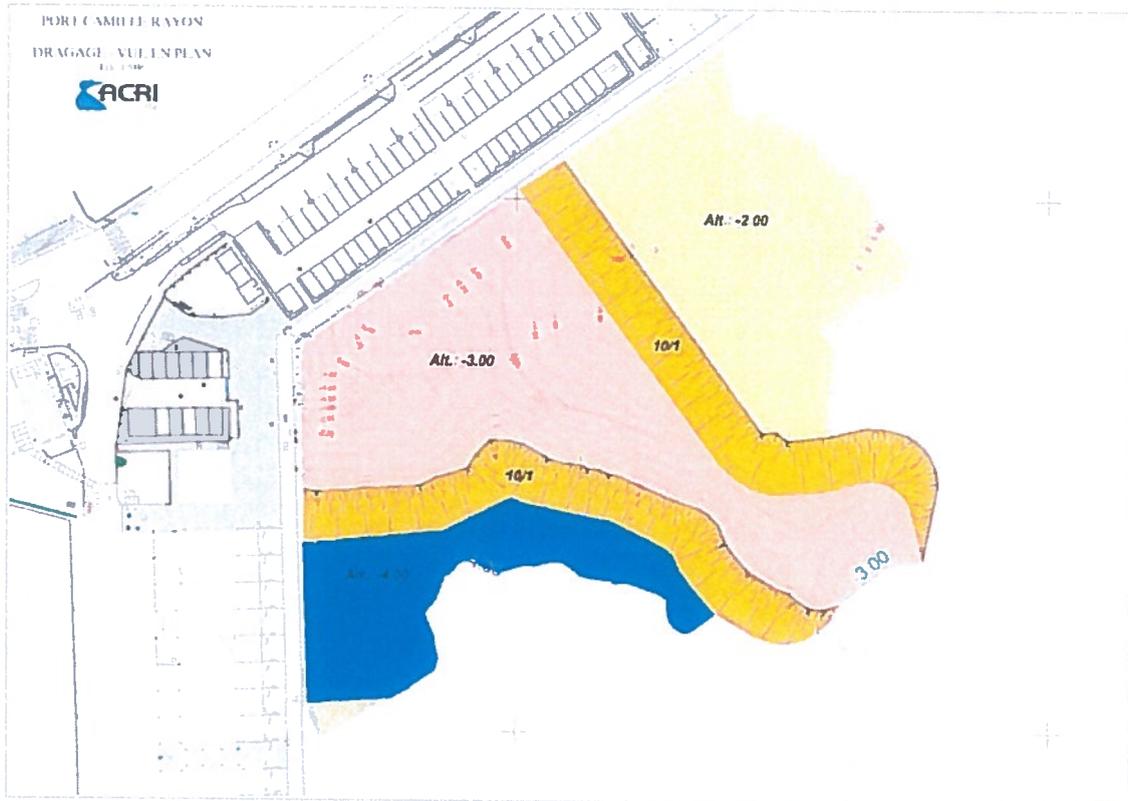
Zoom sur la zone projet - Plan projet de la zone de dragage
